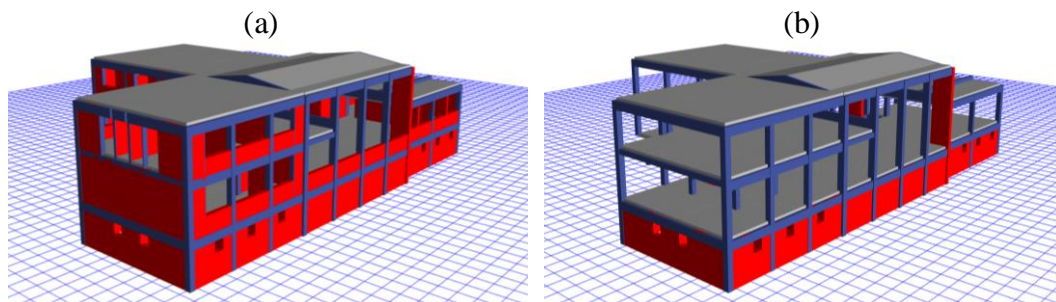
(a) Modelo considerando muros albañilería, (b) Modelo de marcos de hormigón armado.
